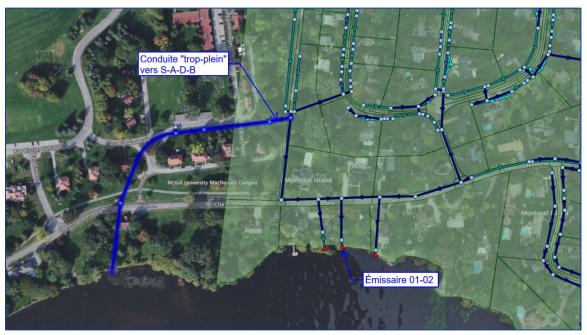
Conduite trop-plein vers Sainte-Anne-de-Bellevue – Vue en plan
